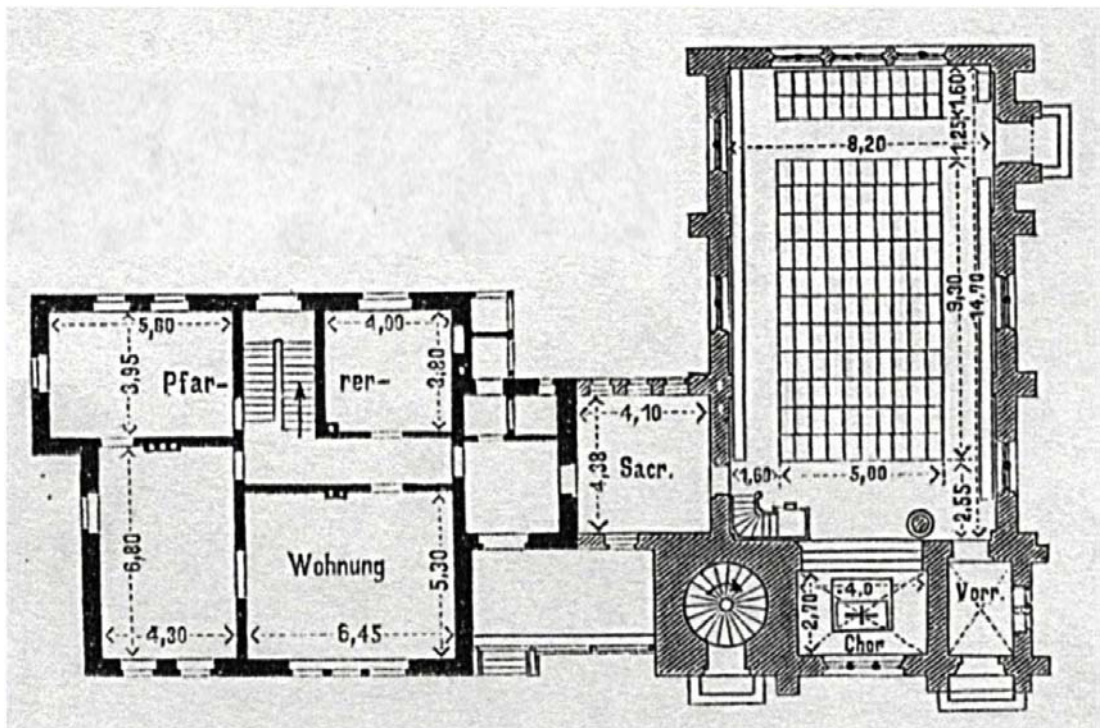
Grundriss Erdgeschoss der Gebäudegruppe
